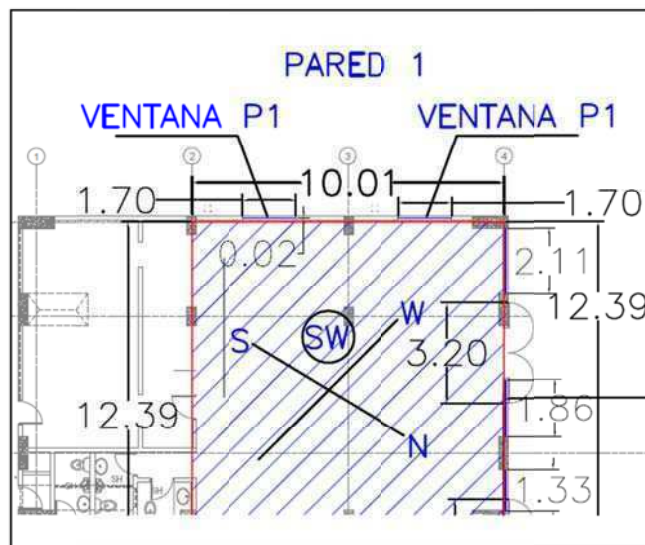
Vista de planta .de la pared 1 y ventanas 1
